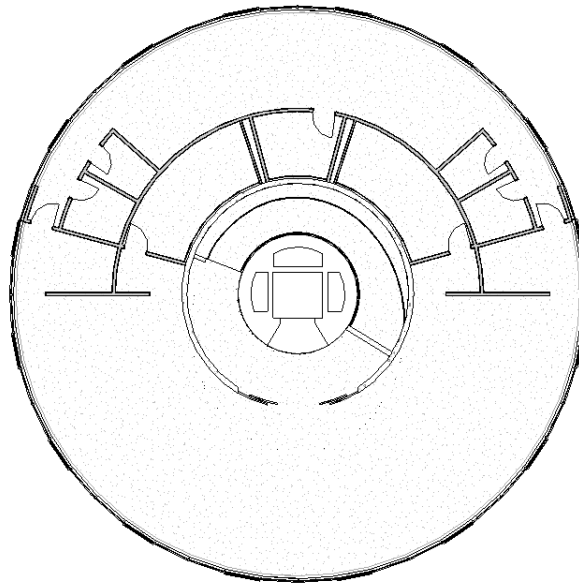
Particiones de la planta nivel mirador (Vista de planta Nivel Mirador)
